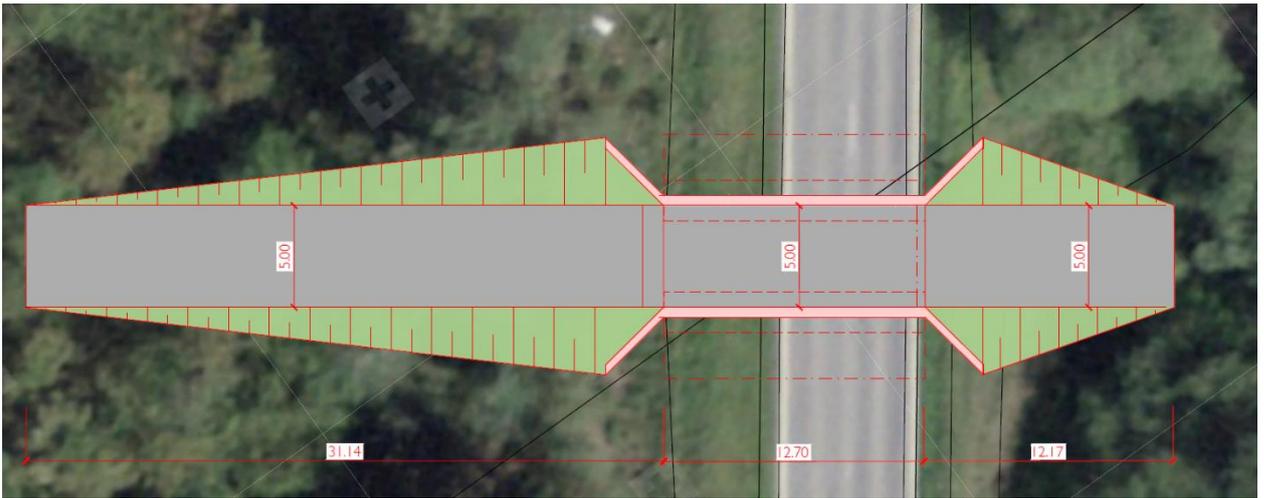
Nuovo passaggio faunistico zona Malvaglia – pianta
